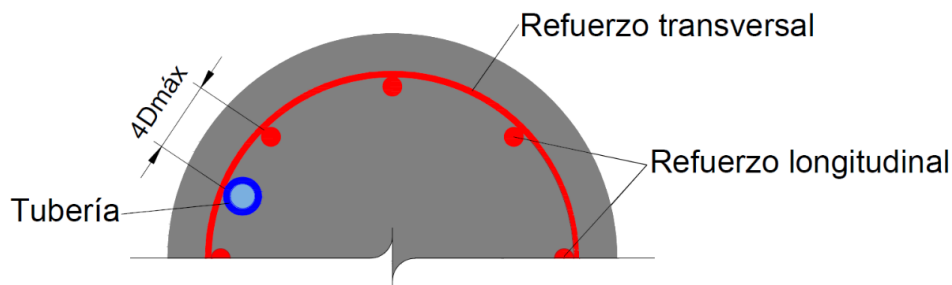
Separación mínima entre tuberías y refuerzo longitudinal
